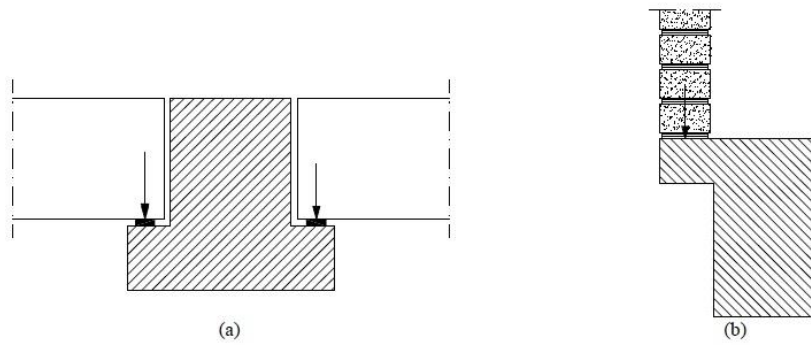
(a) e (b) - Vigas com carregamento excêntrico [6]
